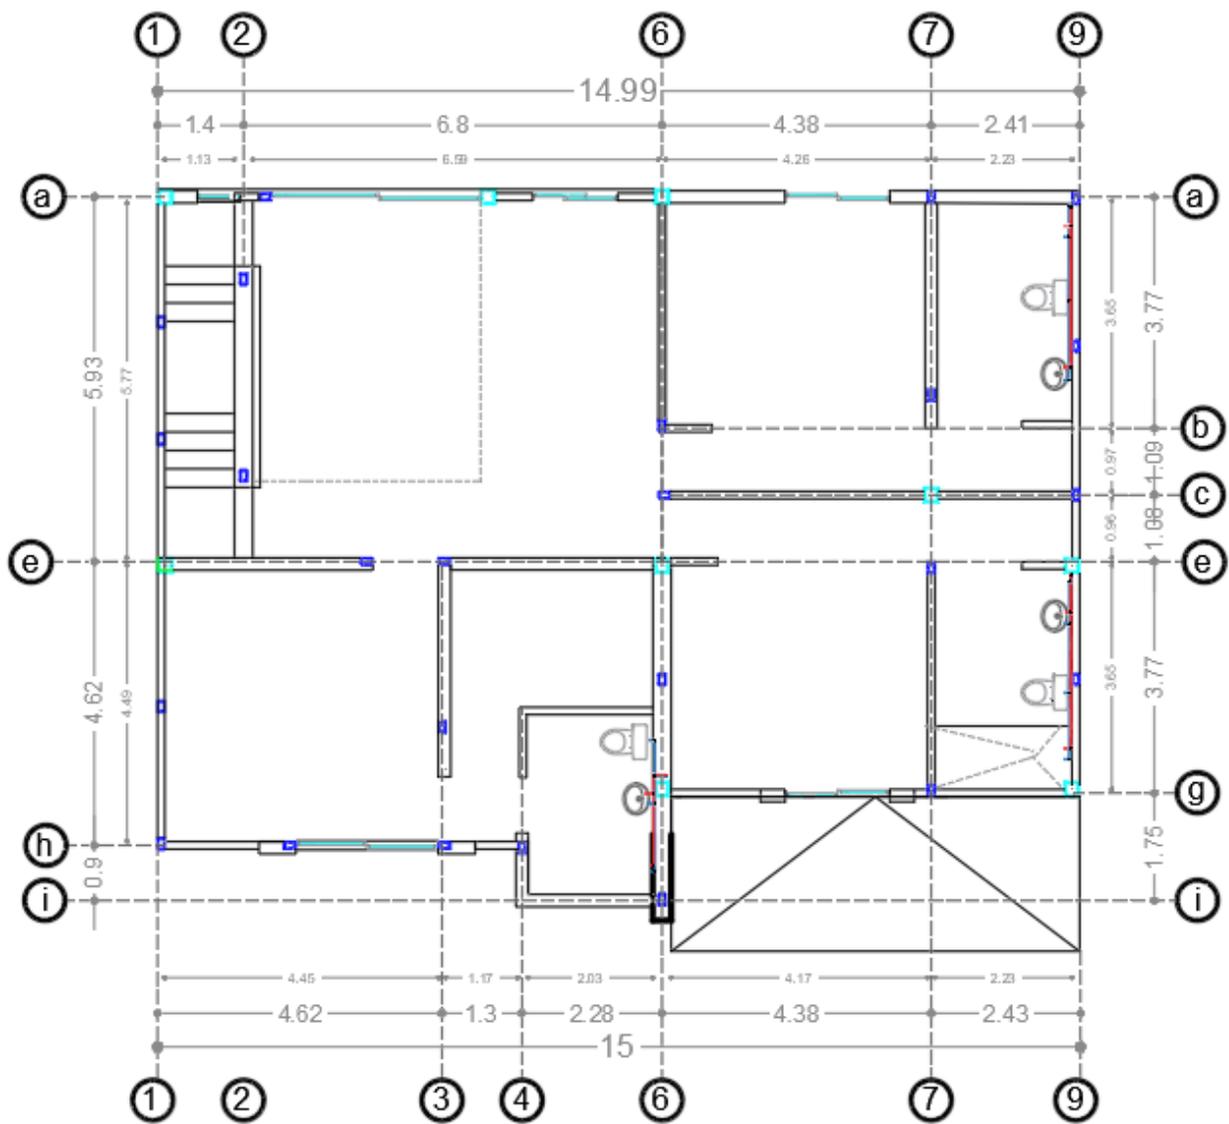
Plano hidráulico planta alta (Muciño, 2022)
